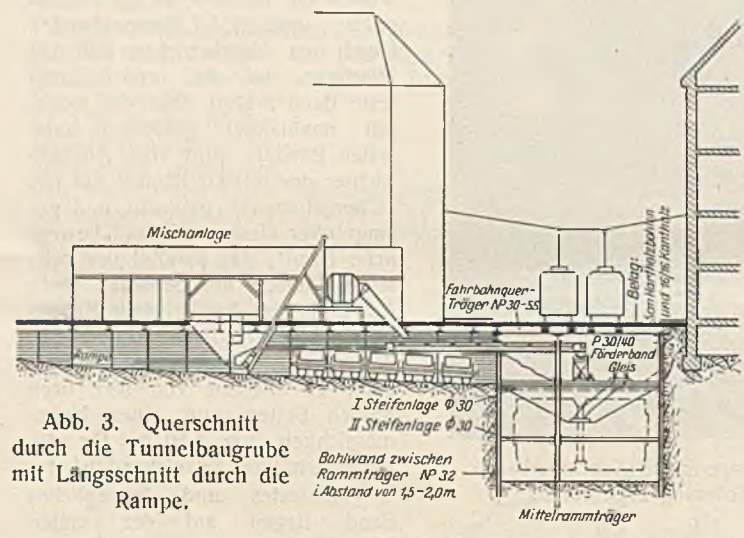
Querschnitt durch die Tunnelbaugrube mit Längsschnitt durch die Rampe.
